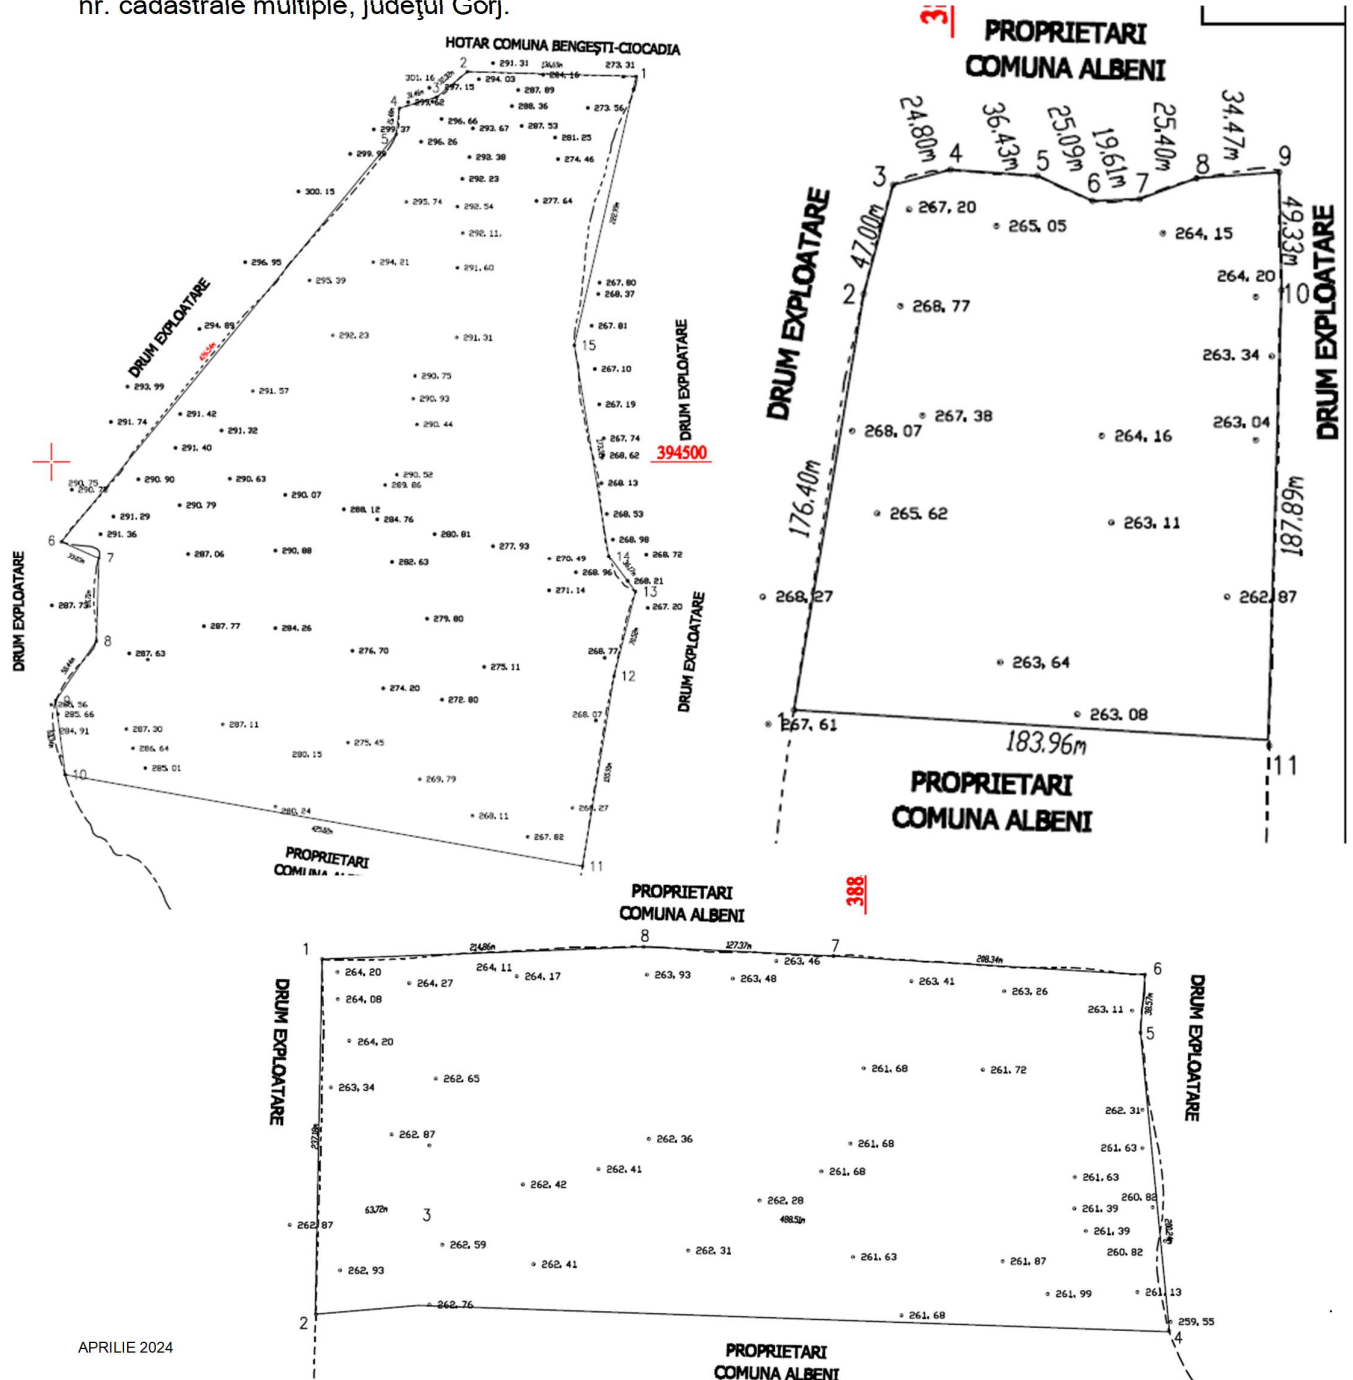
Plan de situație și Plan de amplasament a obiectivului
